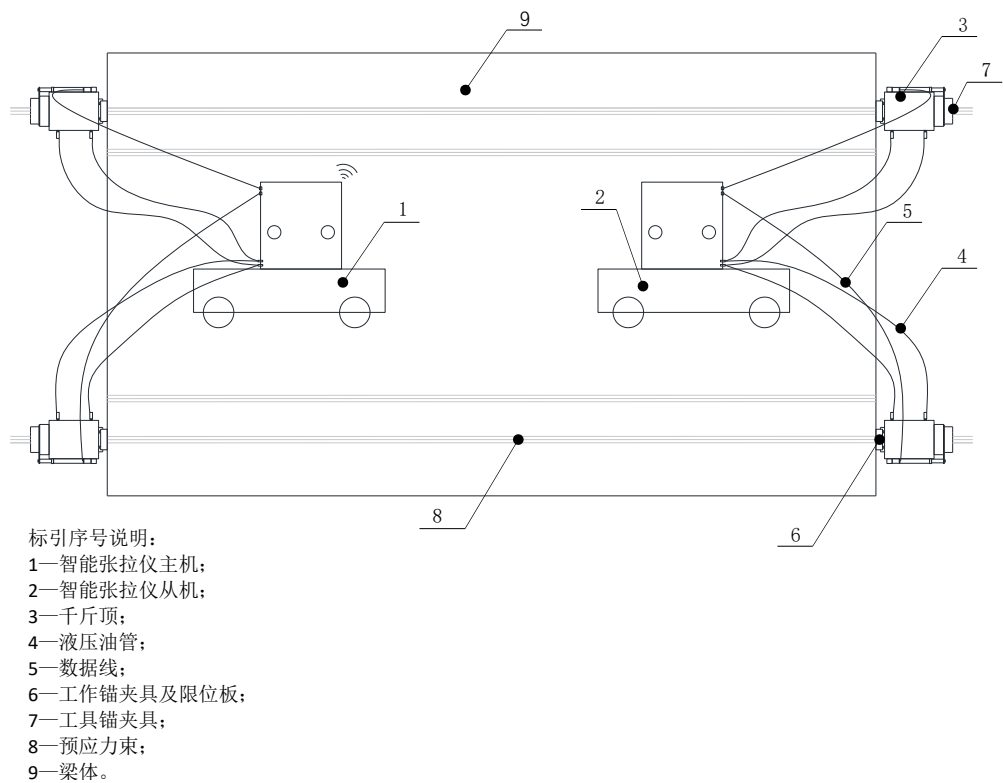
预应力混凝土现浇梁智能张拉设备连接示意图
